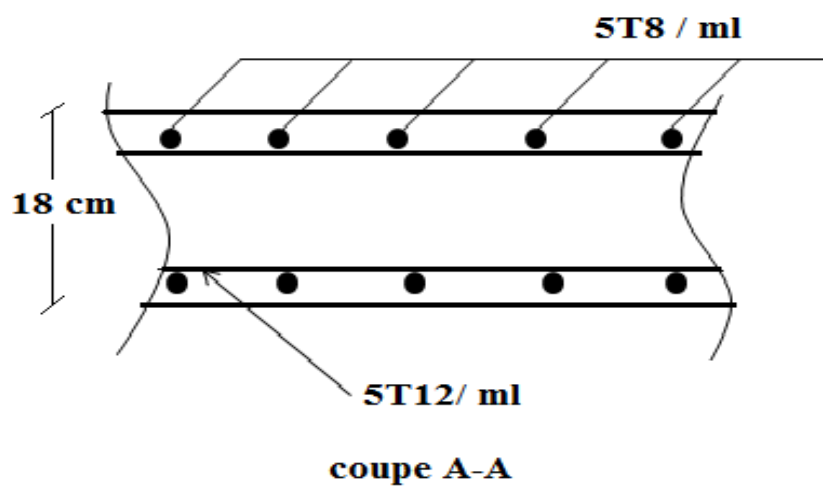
Ferrailage de balcon type 1 et 2.
